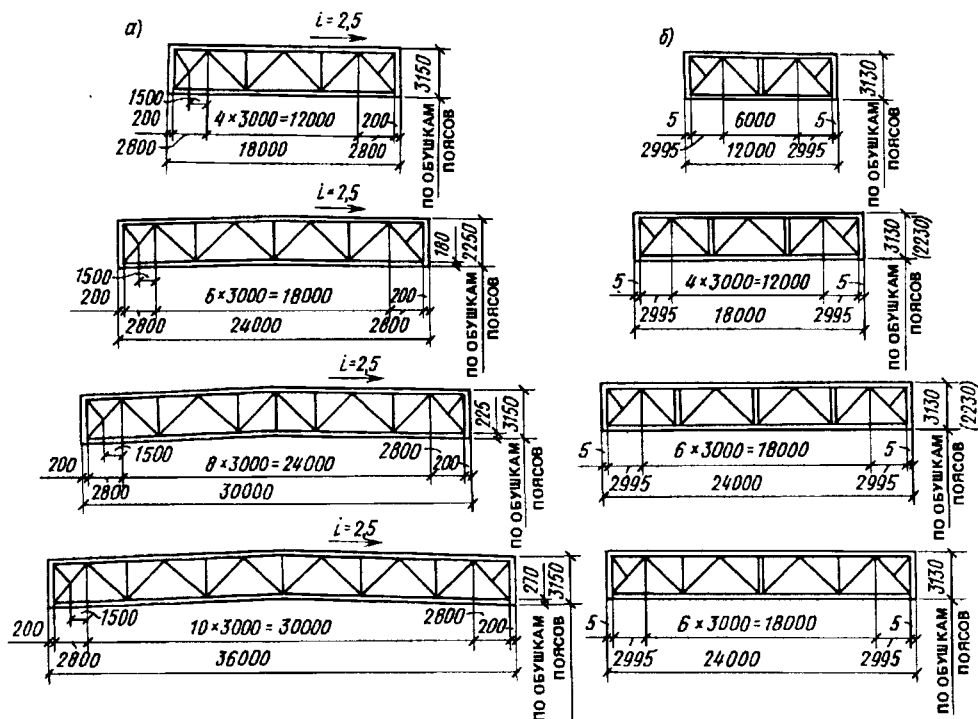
Типовые схемы стропильных (а) и подстропильных (б) ферм для покрытий с уклоном кровли 2,5%
